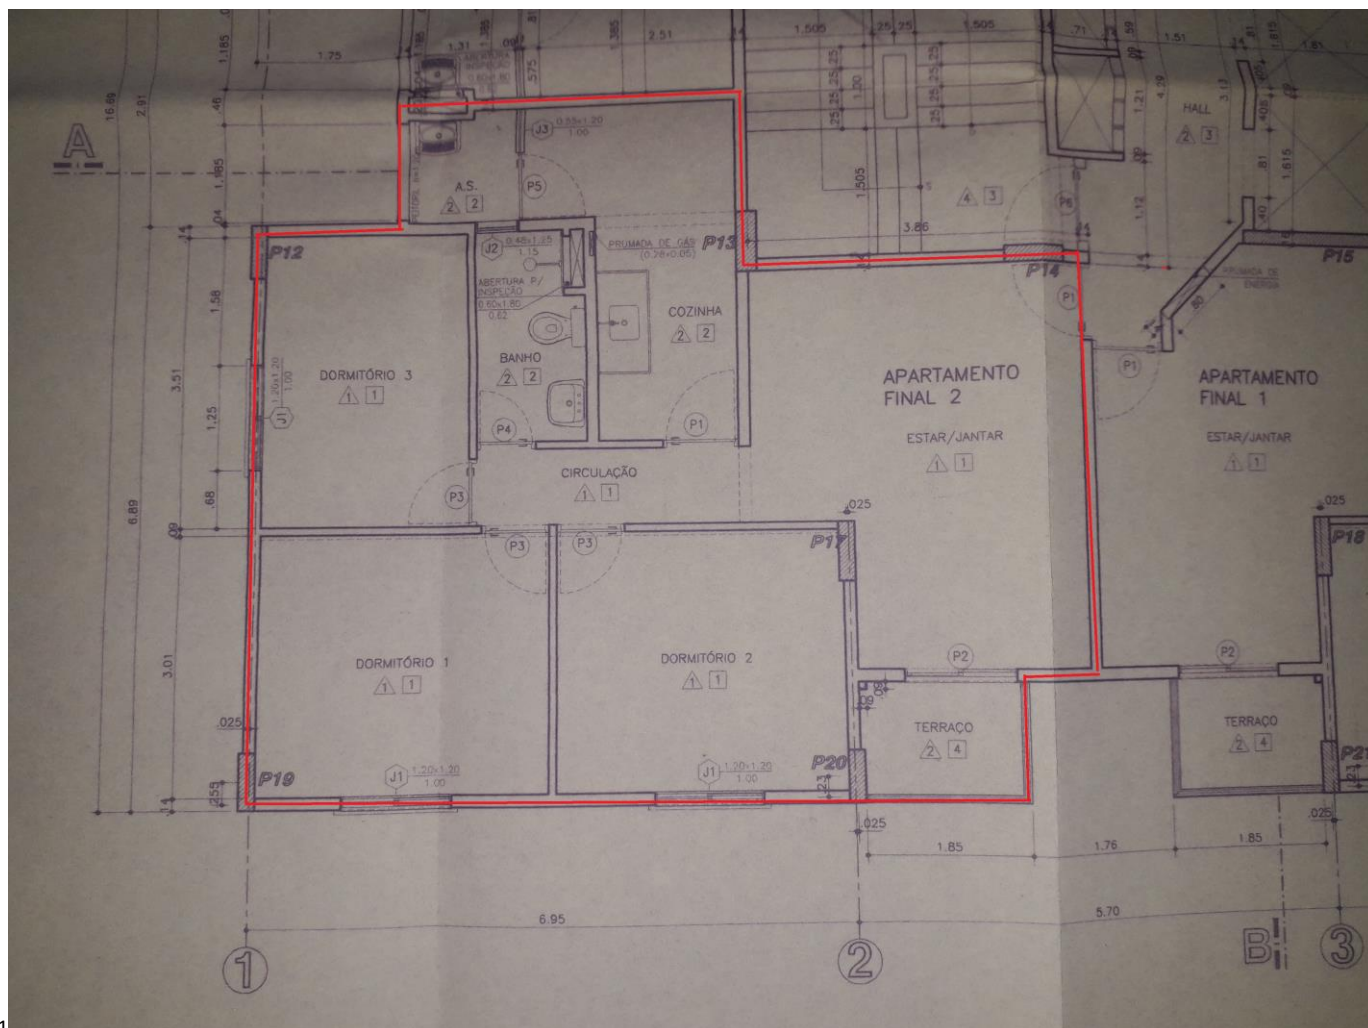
(ANEXO IV) – Planta baixa retratando as dependências do imóvel avaliando (prumada final 2).
